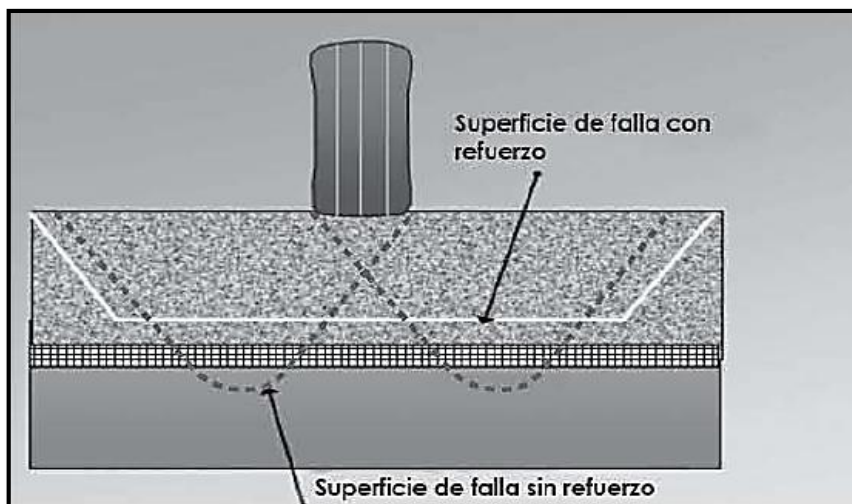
Superficie de falla con refuerzo y sin refuerzo.
